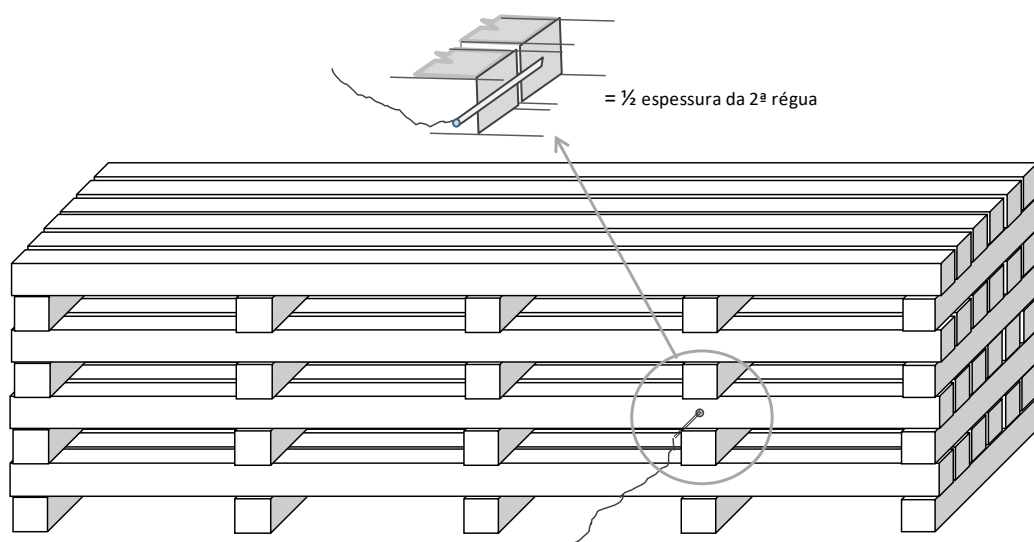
Correta colocação da sonda numa pilha de perfis de secção quadrada (Quadradilho)
